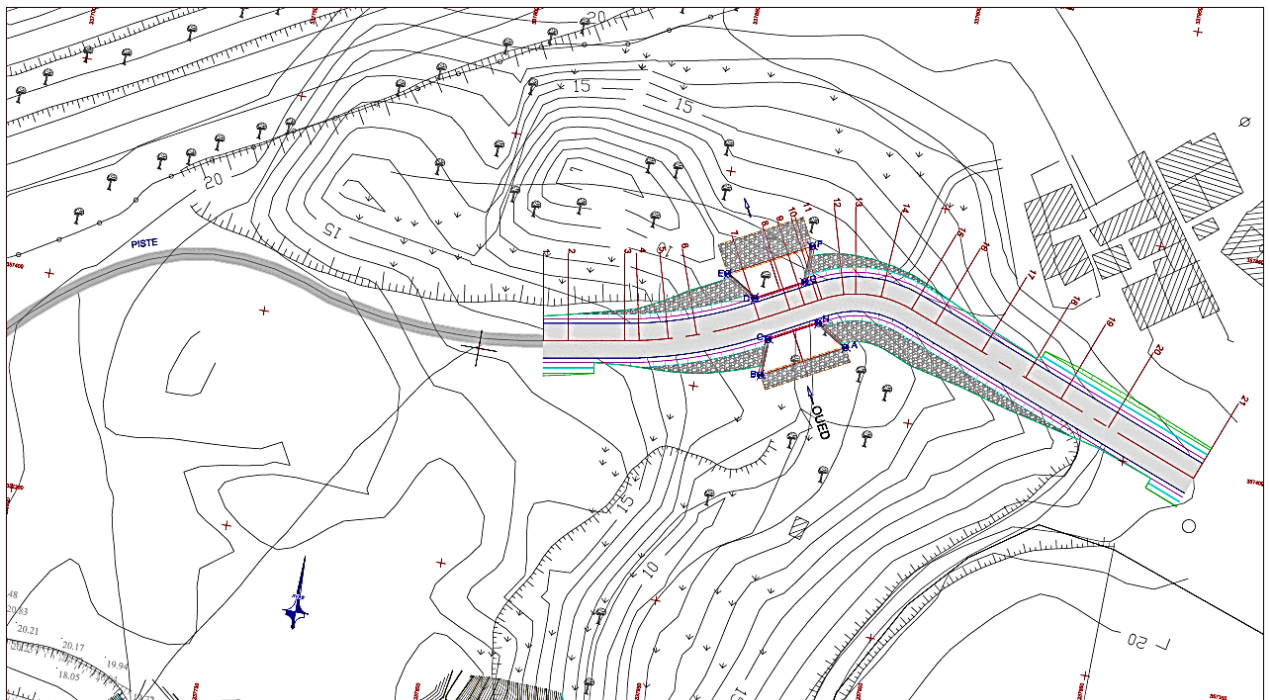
Tracé en plan de l'ouvrage Hydraulique 2 (OH2)
